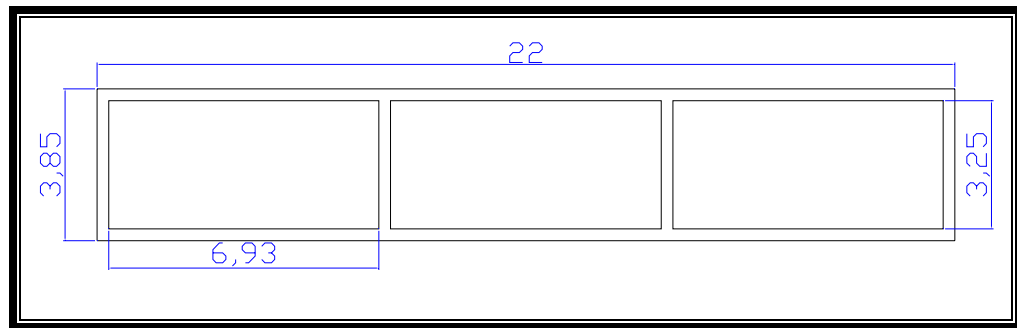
Dimensiones exteriores e interiores de las pilas de calentamiento.
